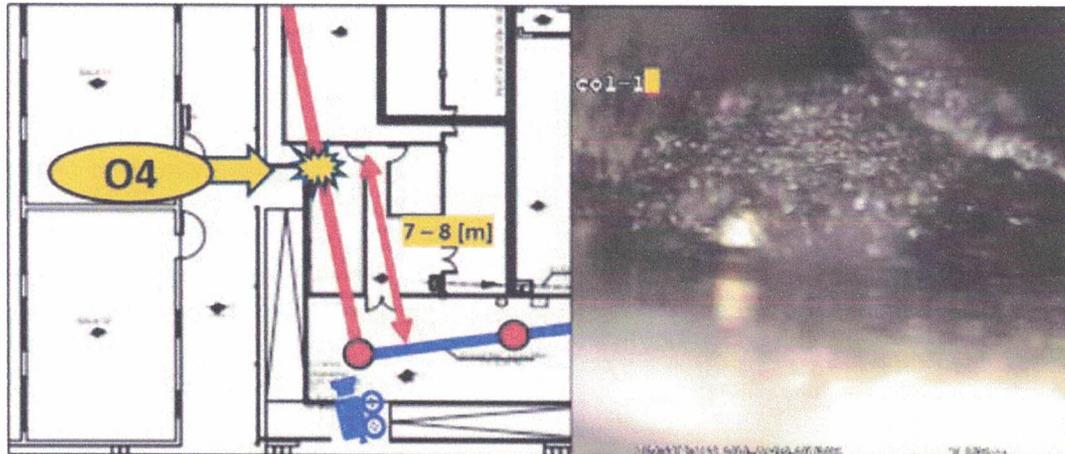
Obstrucción N° 4, además de la Imagen tomada durante la video inspección.
